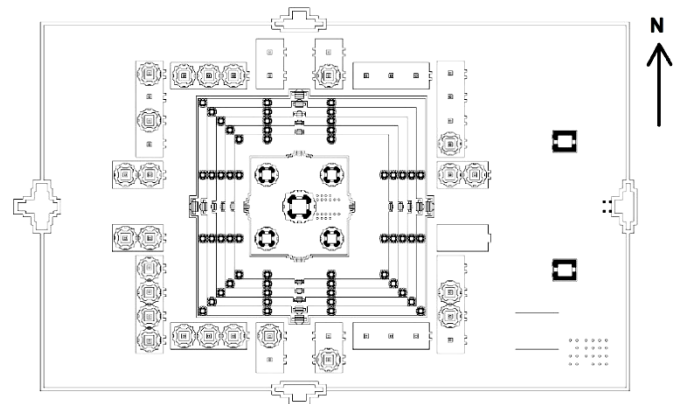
Planta del templo montaña de Bakheng, cuya construcción se inició en el año 893.
